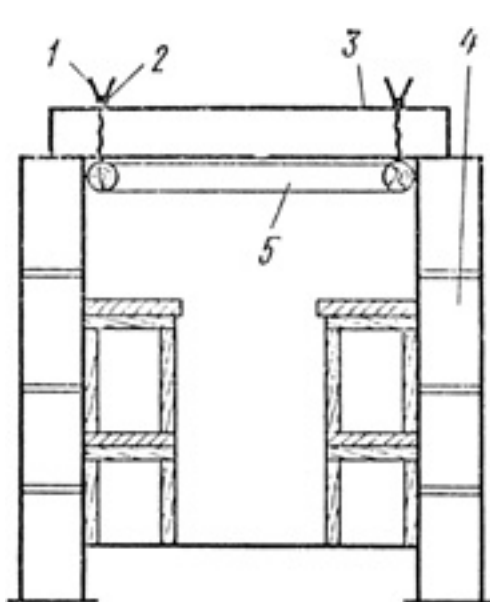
Поперечный разрез убежища, возводимого с использованием для стен бетонных блоков: 1 – проволочные скрутки; 2 – продольный арматурный стержень; 3 – железобетонная плита; 5 – деревянная рамная распорка
